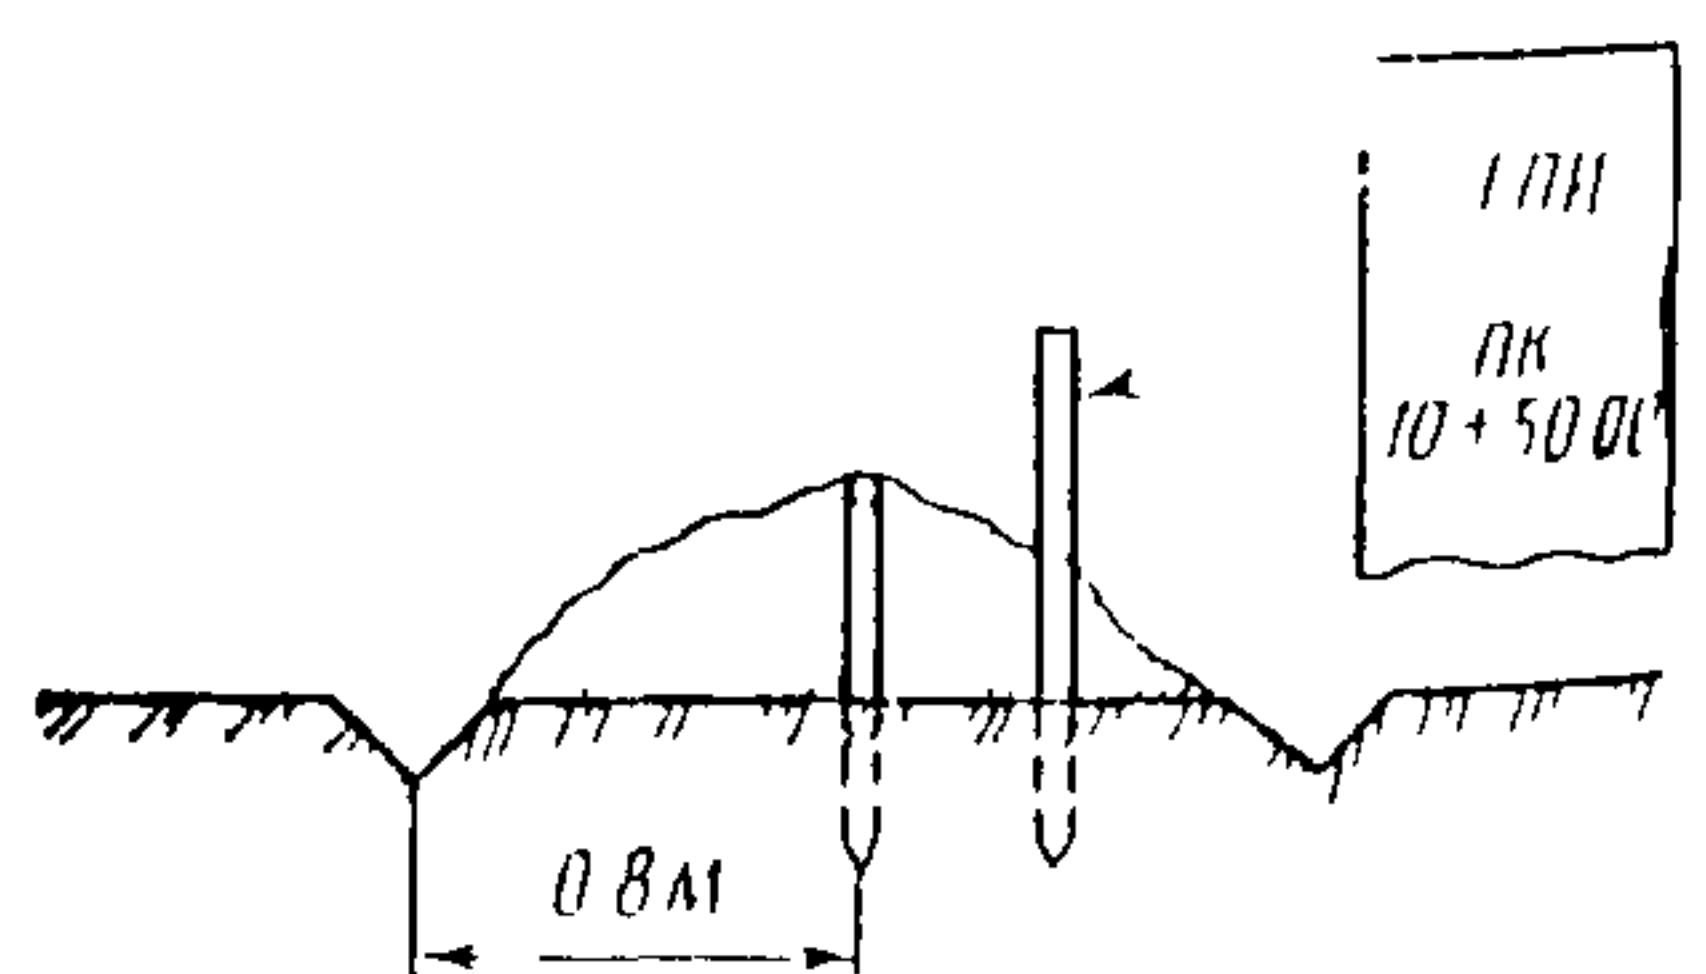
Схема закрепления угла поворота, размещенного за пределами строительных работ
